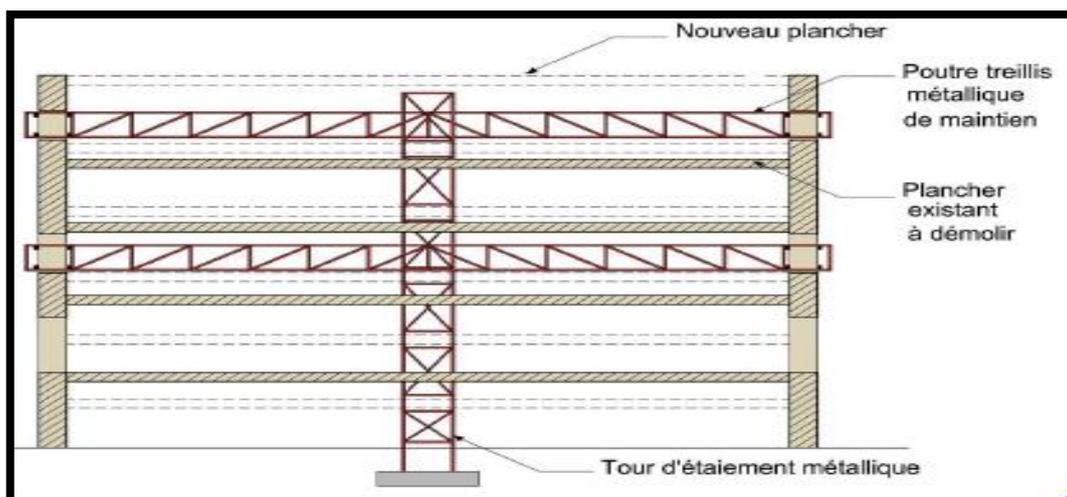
exemple d'étaie volant de façade à façade avec une tour d'appuie au centre
